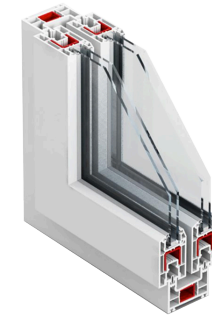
Perfil de PVC con doble vidrio con tinte. Elaboración: Desconocido. Fuente: Plataforma Arquitectura
